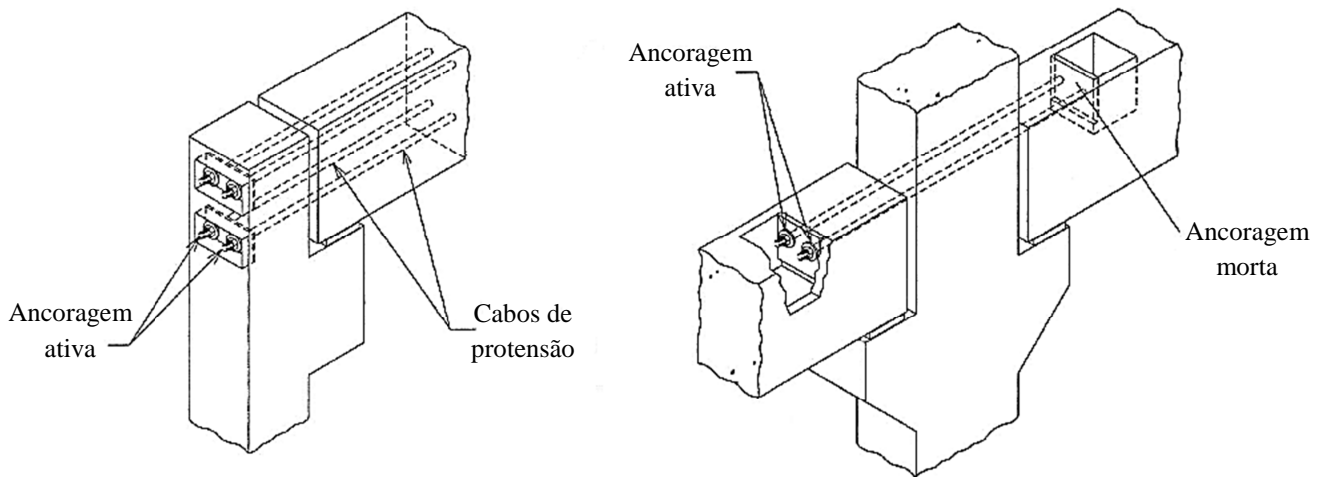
Ligações viga - pilar rígidas com cabos de protensão [EL DEBS (2000)].
